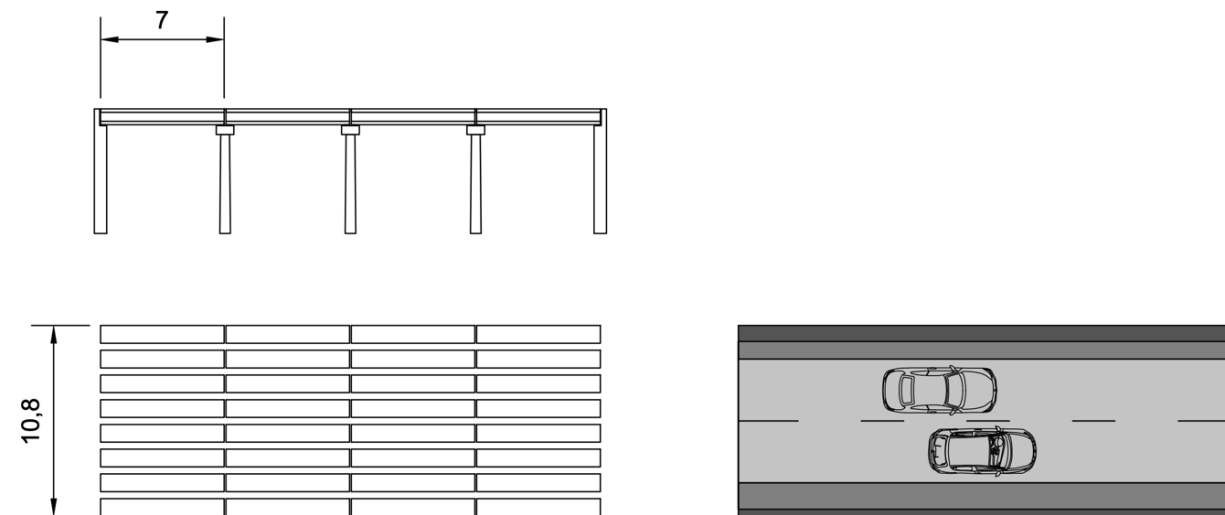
Planteamiento paso superior. | Fuente: Elaboración propia
